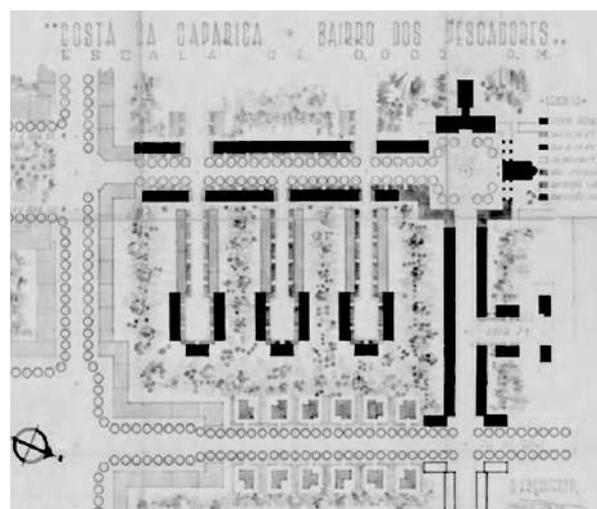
Bairro de Casas para Pescadores de Costa da Caparica — planta geral do piso 0.
